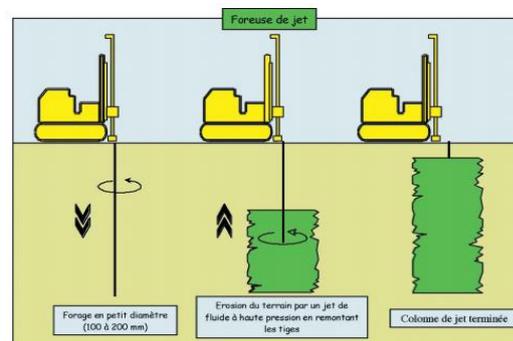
Le Very High Pressure grouting (VHP) ou jetgrouting
